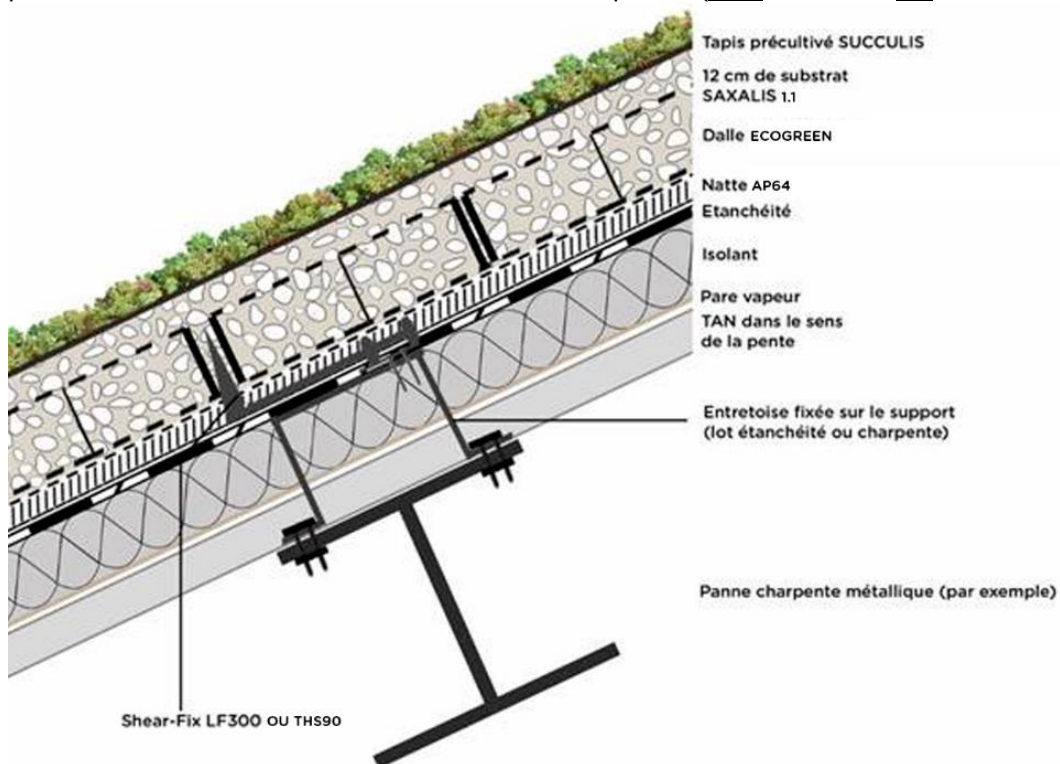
EXEMPLE DE FIXATION DES CROCHETS INTERMEDIAIRES TSH 90 OU SHEAR FIX LF300 SUR ENTRETOISE (DITO DTU 40.35 § 6.4.4) A LA STRUCTURE PORTEUSE AU TRAVERS DE TOILES D'ACIER NERVUREES
